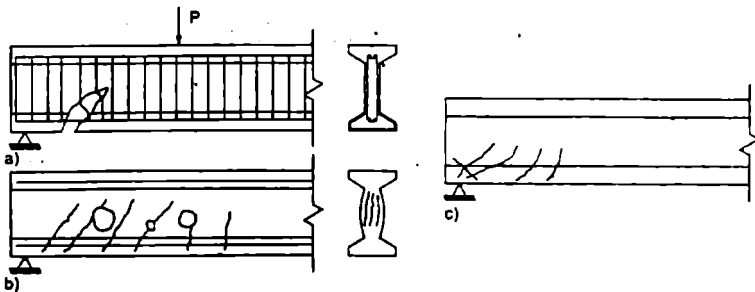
Situações de colapso em uma viga devidas ao cisalhamento: a) escoamento da armadura; b) esmagamento do concreto; c) falha na ancoragem.
